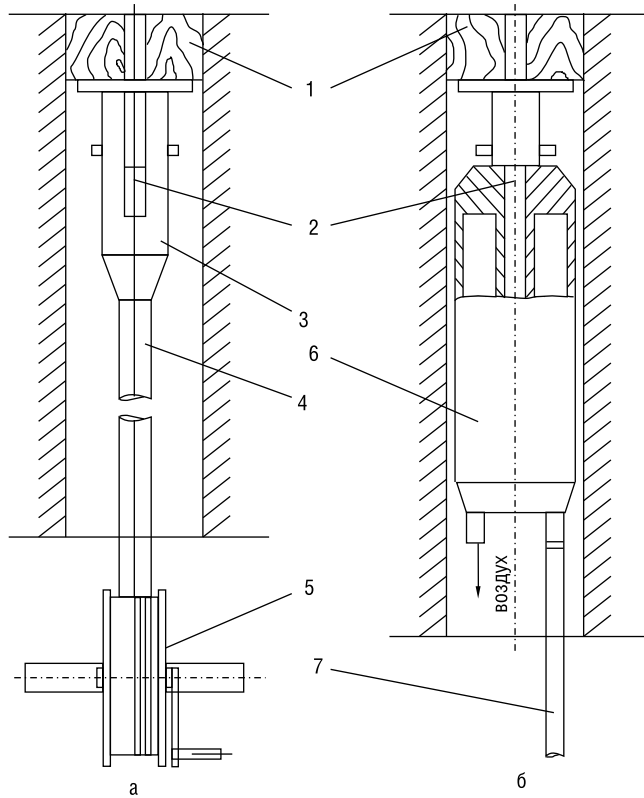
Устройство для закрепления реперов: а, б - соответственно с ручной лебедкой и реактивной установкой; 1 - глубинный репер; 2 - проволока связи; 3 - установочная головка; 4 - штанга; 5 - лебедка; 6 - реактивный снаряд; 7 - воздушный резиновый шланг.
